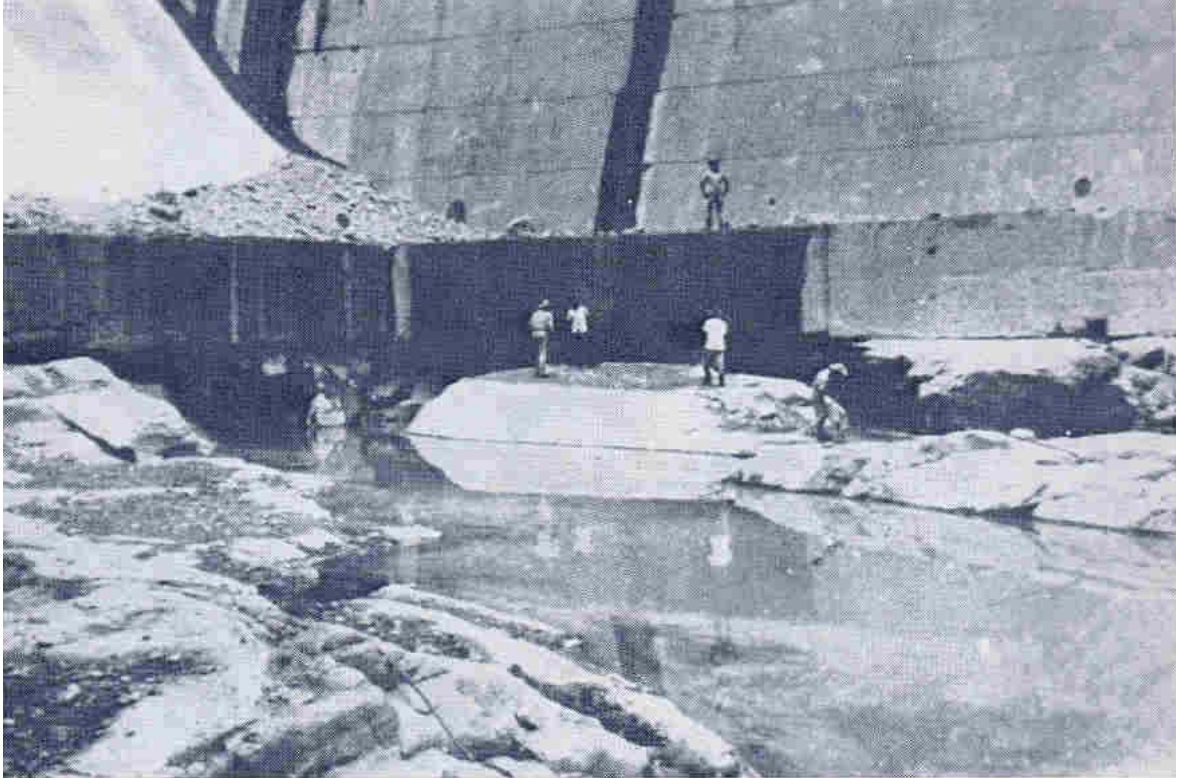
Arrancamento de lajes na bacia de dissipação da Barragem Malpaso. Sanchez Bribiesca e Capella Viscaino (1973).
